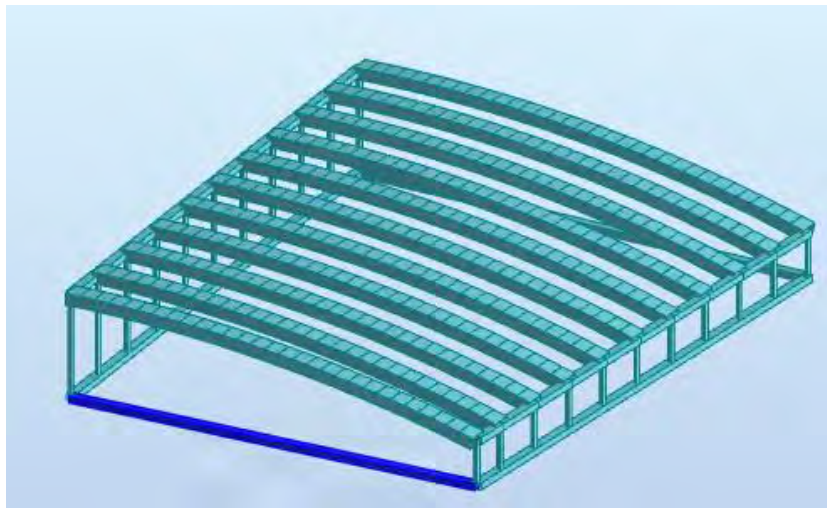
SITUACIÓN DE LA VIGA
